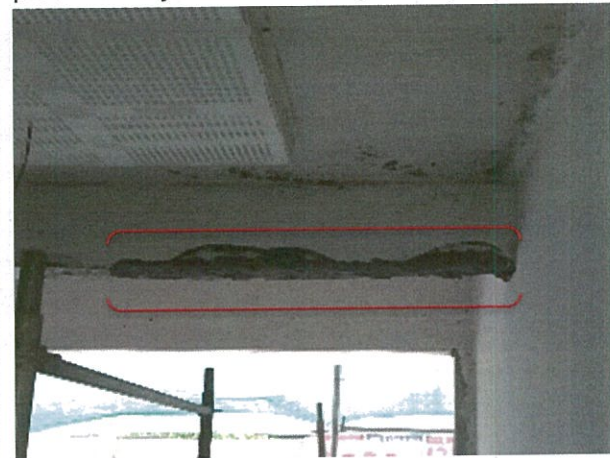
, 30-06-2015, viga con enfierradura a la vista, ubicada en segundo piso en el eje D entre los ejes 23 y 24.
